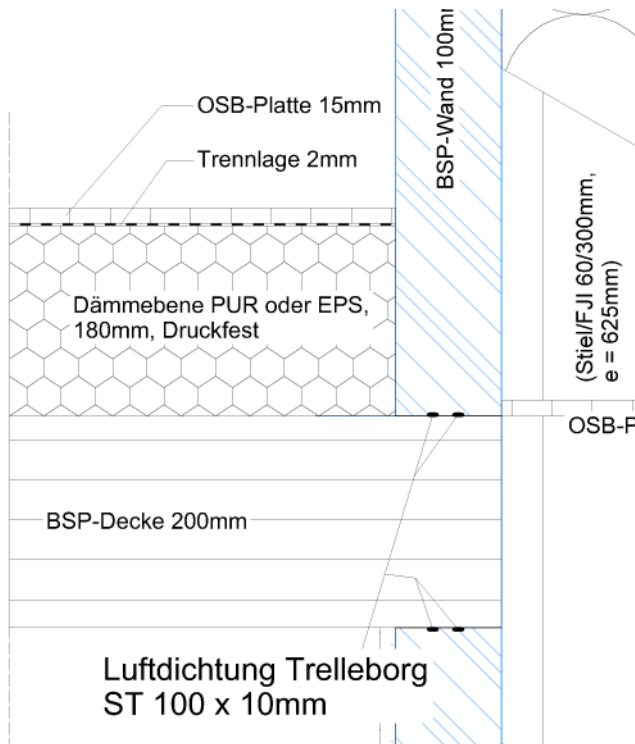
Decke gegen Terrasse-AW (Innendecke)
